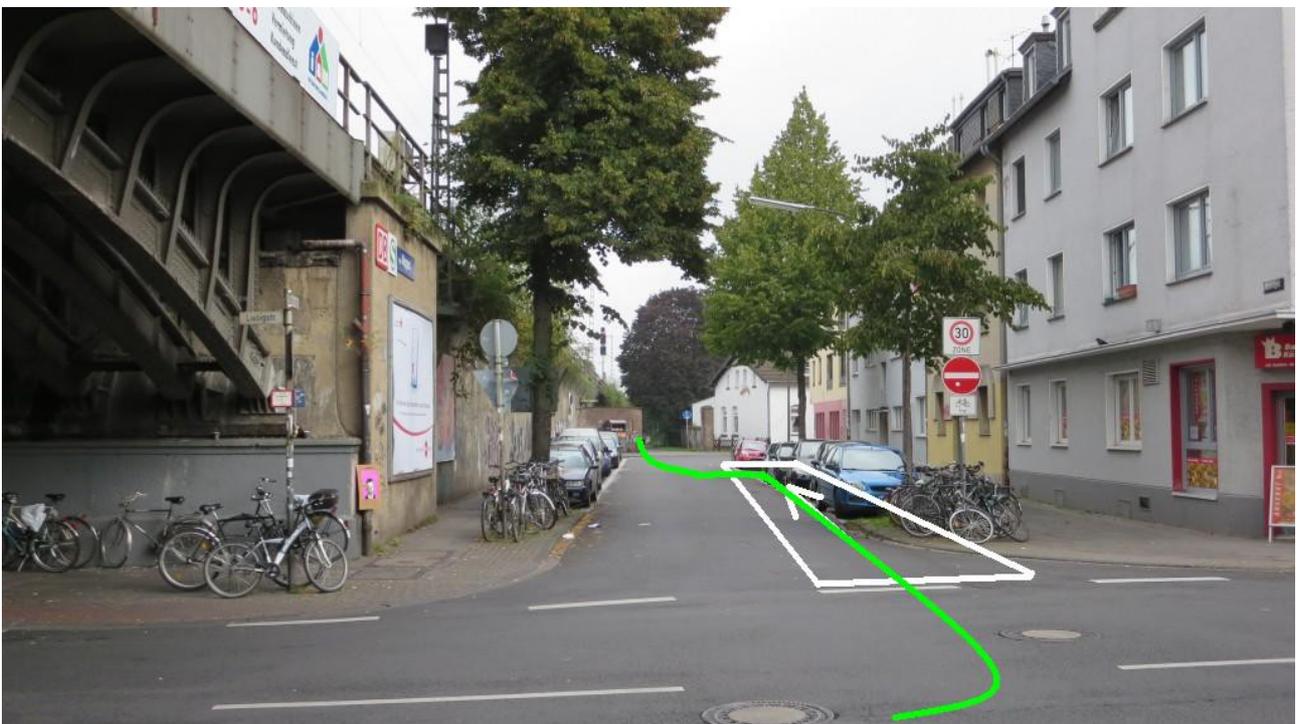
Öffnung Sechzigstraße für Baustellenzufahrt.
